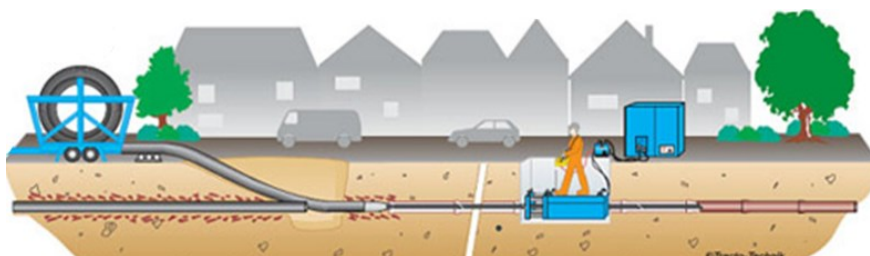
Substituição de Tubulações por Arrebentamento com Sistema Hidráulico (Estático).
